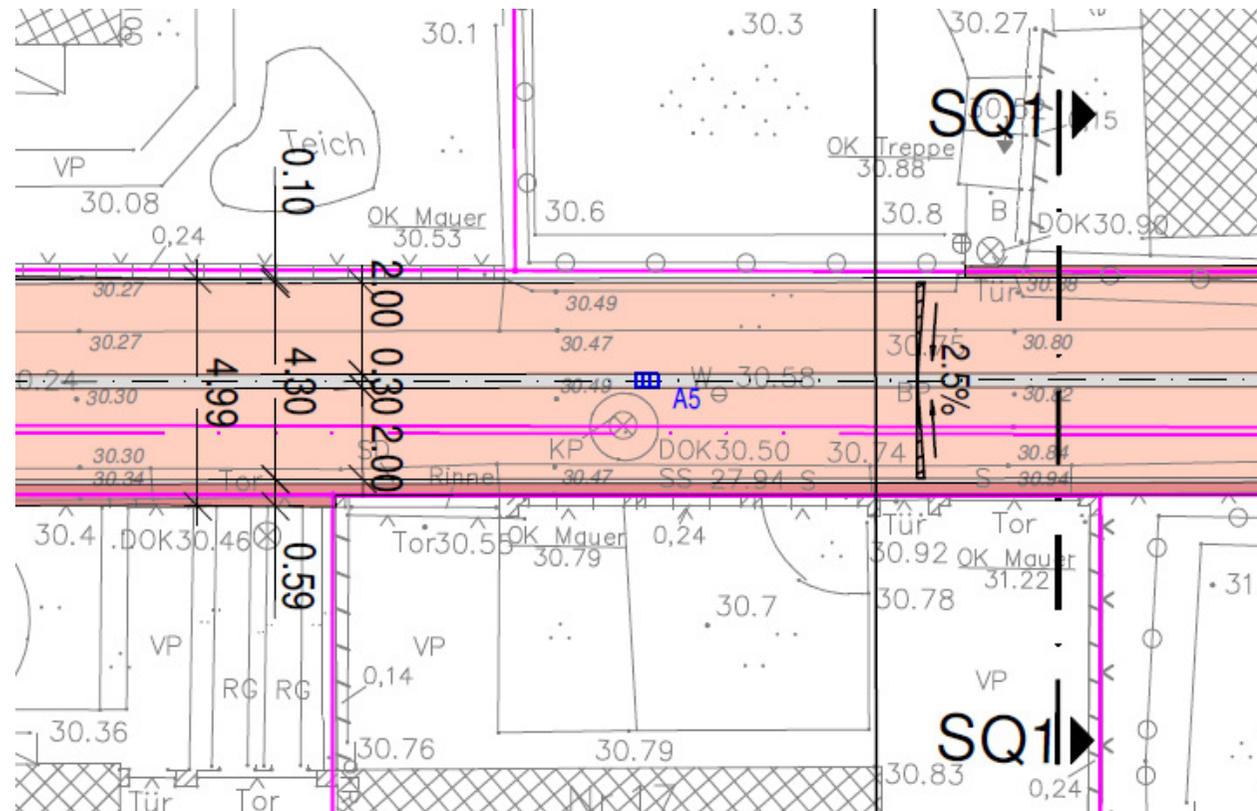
Lageplanausschnitt Vorzugsvariante mit 4,30 m Fahrbahnbreite
